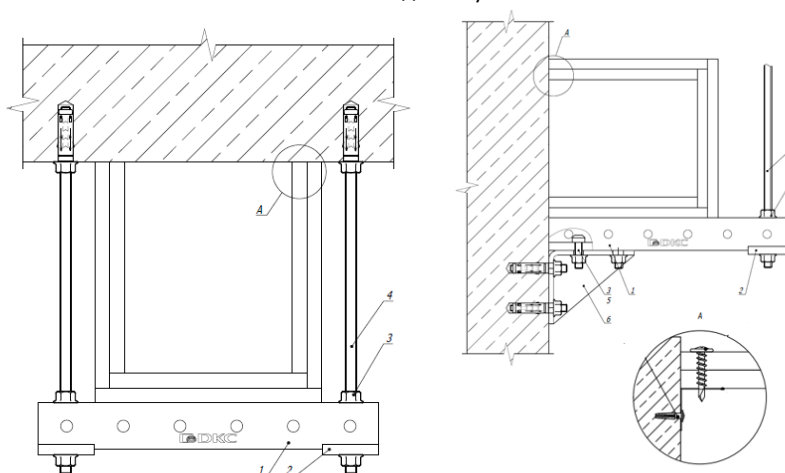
Крепление короба с тремя стенками к несущей поверхности
